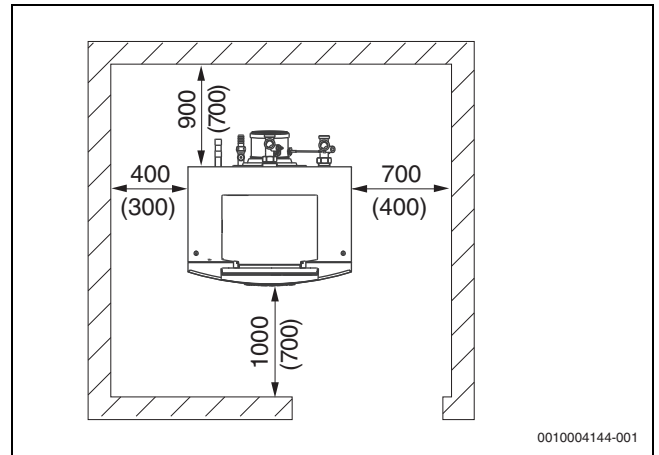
Wandabstände im Aufstellraum: Empfohlene und minimale Wandabstände (alle Maße in mm)
